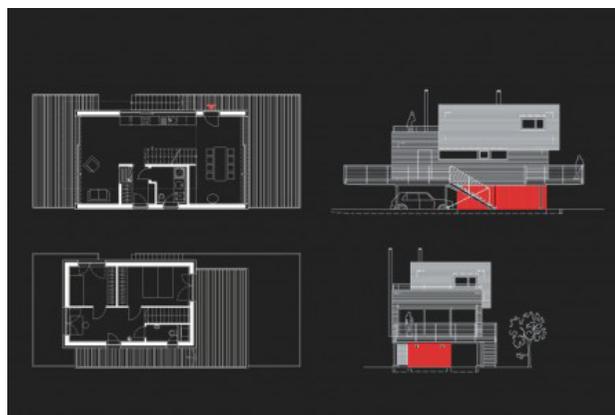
Badehaus I Grundrisse und Ansichten
